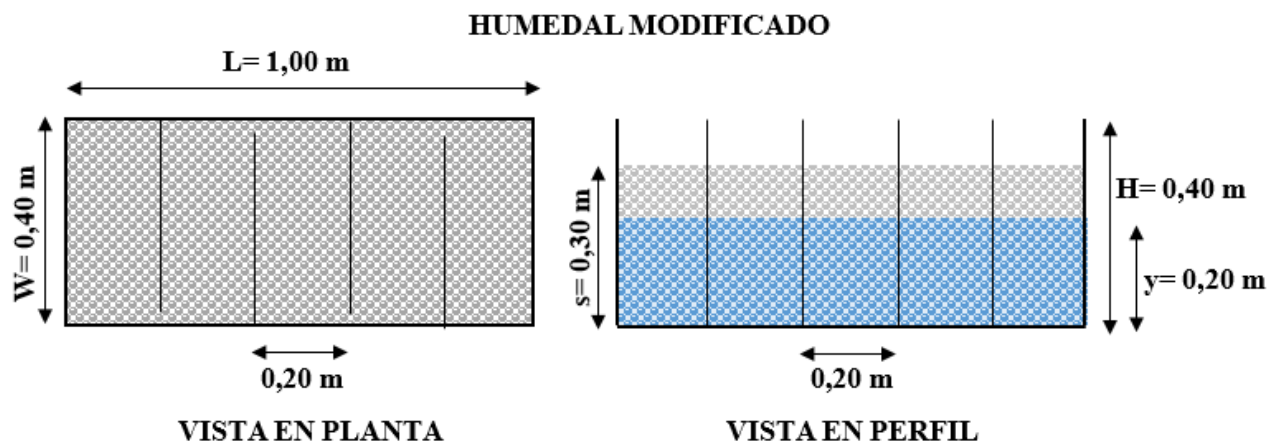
Vista en Planta y de Perfil de Humedal Modificado
